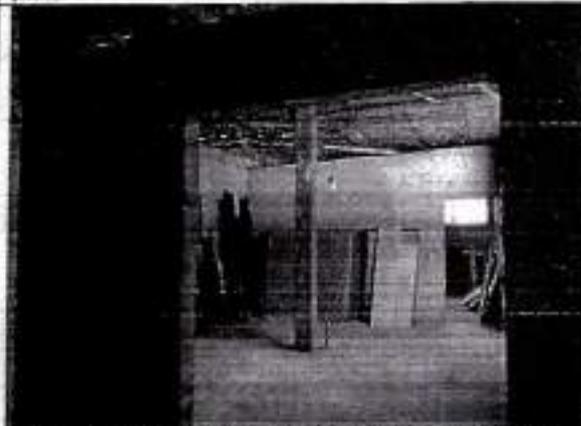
Vista del proceso constructivo en el segundo piso.
